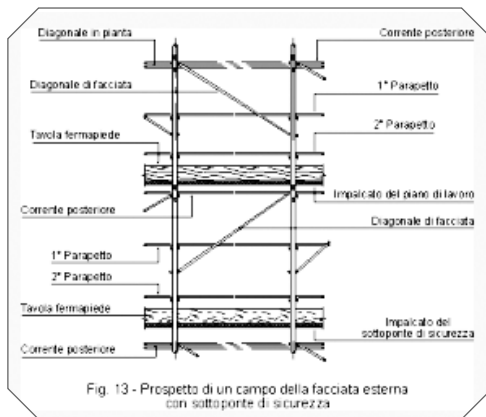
Prospetto di un campo della facciata esterna con sottoponte di sicurezza
